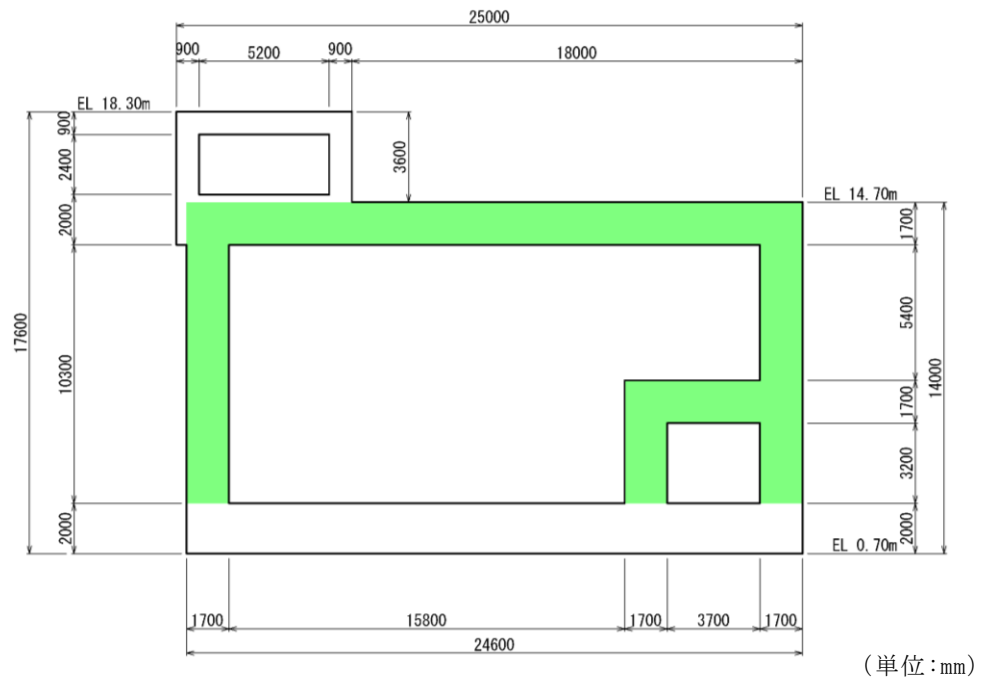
第 1 ベントフィルタ格納槽 断面図 (A-A 断面)
